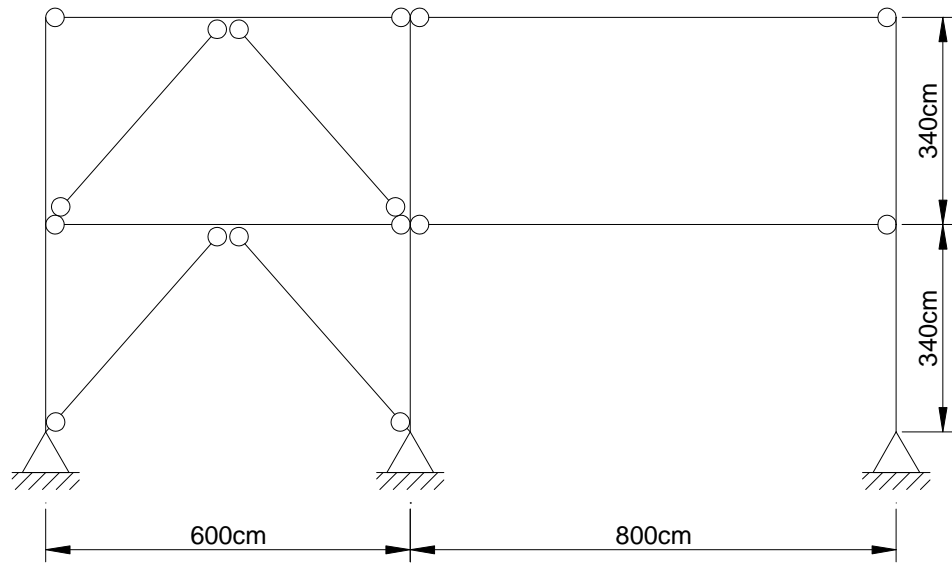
Tipologia utilizada no pórtico plano contraventado com barras de aço do caso A1.
